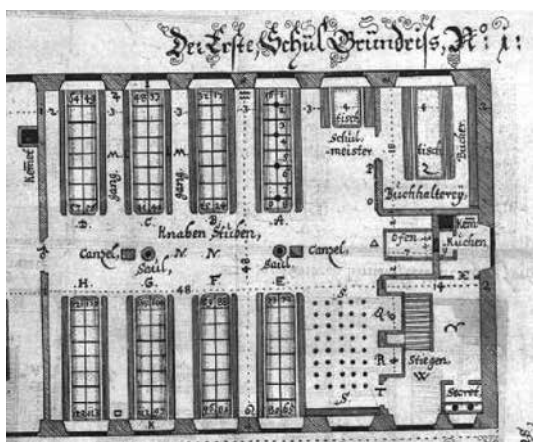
Й. Фурттенбах. Німецька шкільна будівля. Фрагмент плану другого поверху (приміщення для хлопчиків). 1649.
